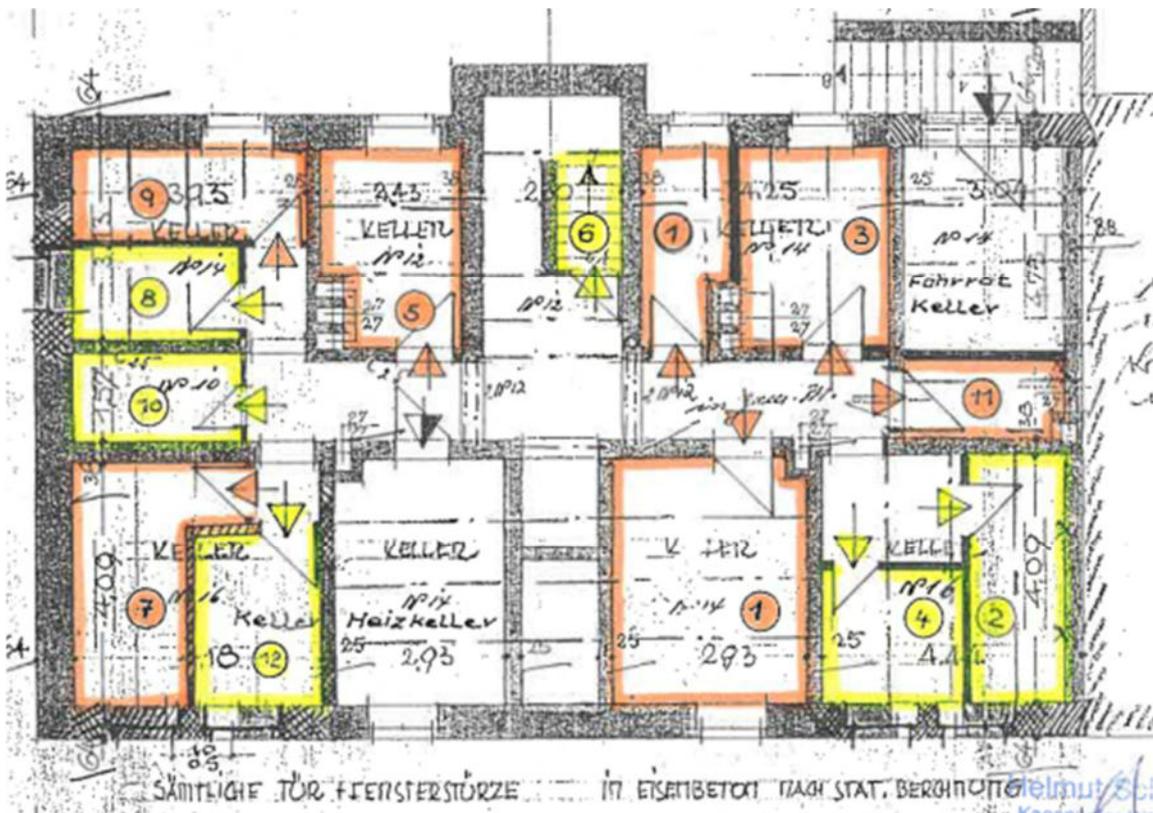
Grundriss Kellergeschoss (Abteil Nr. 6, Nr. 1 und Nr. 11)
